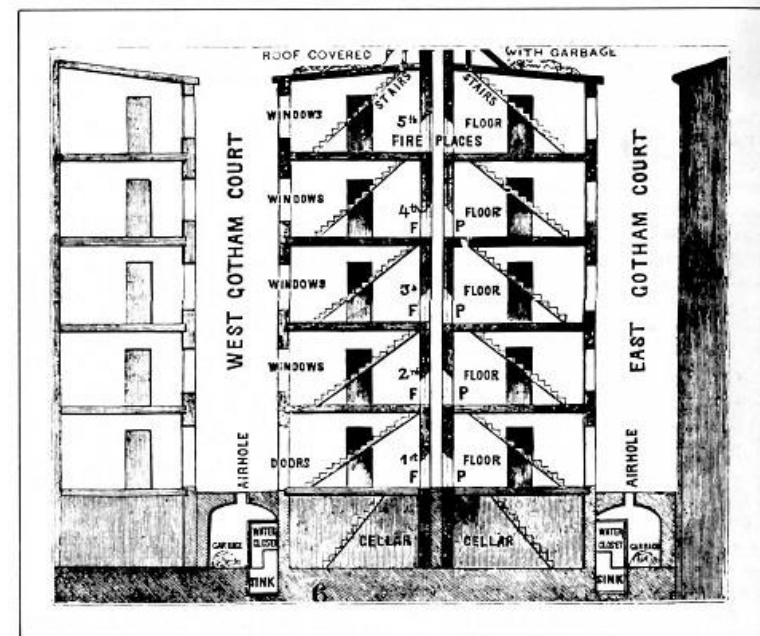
Conjunto de vivienda popular en dos filas paralelas de seis edificios, de seis plantas cada uno alineados a lo largo de un estrecho callejón, situado en Cherry Street 36 en la ciudad de New York, construido en 1850 por Silas Wood.
